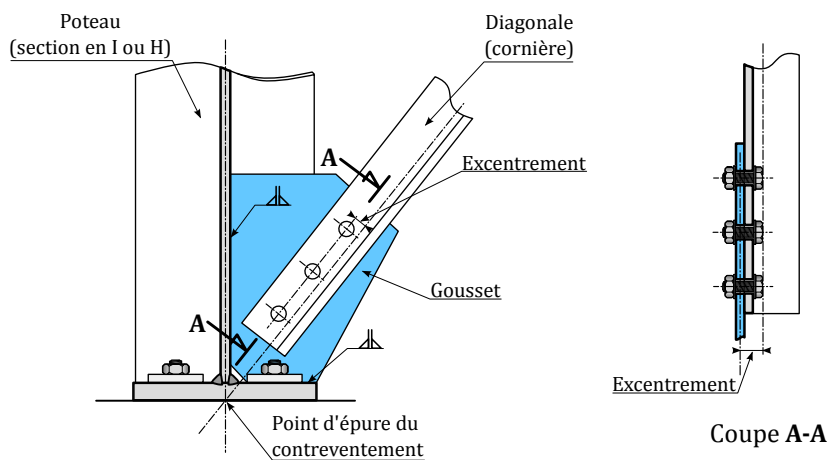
Assemblage d'une diagonale de contreventement sur un poteau
